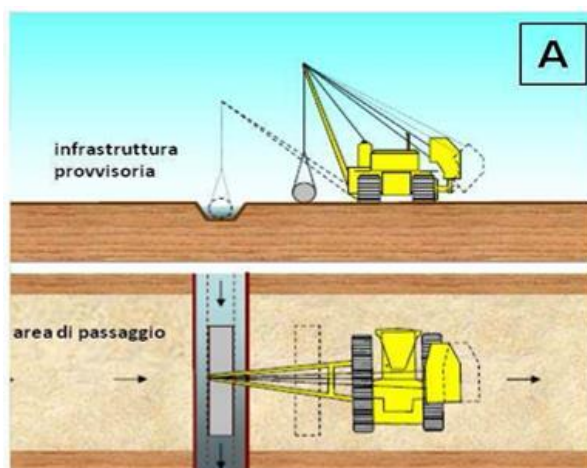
/A - Sezione tipo di un by-pass provvisorio del flusso idrico. Fase 1
